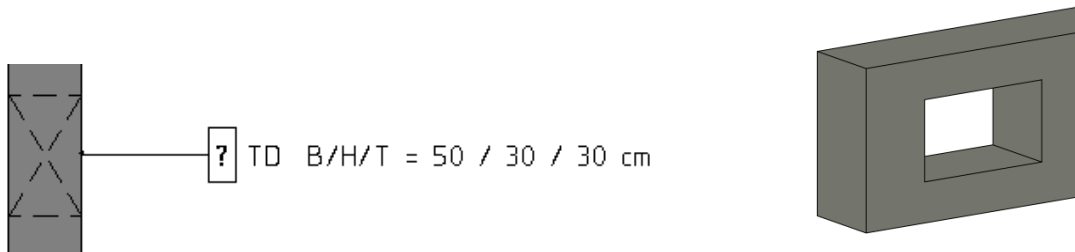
Darstellung einer Trägeröffnung inkl. Beschriftung
